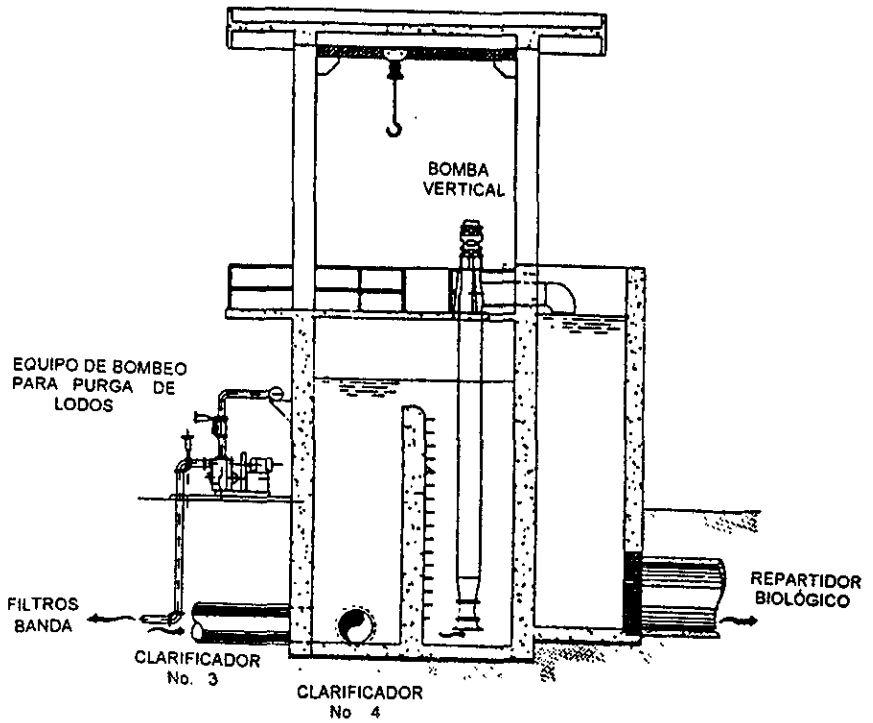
Planta del Cárcamo de Recirculación y Purga de Lodos
